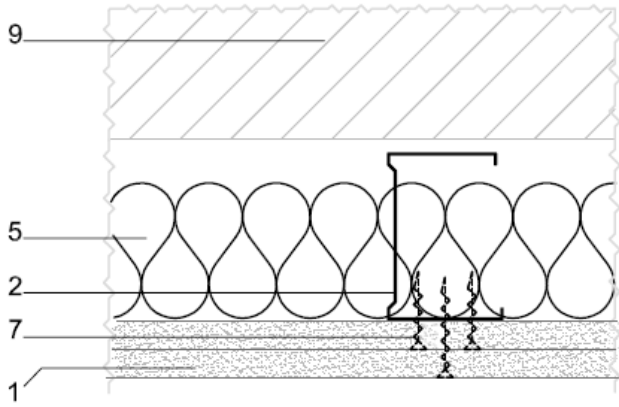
Sección horizontal de un tabique con subestructura doble y panelado simple arriostrado con placa intermedia.
